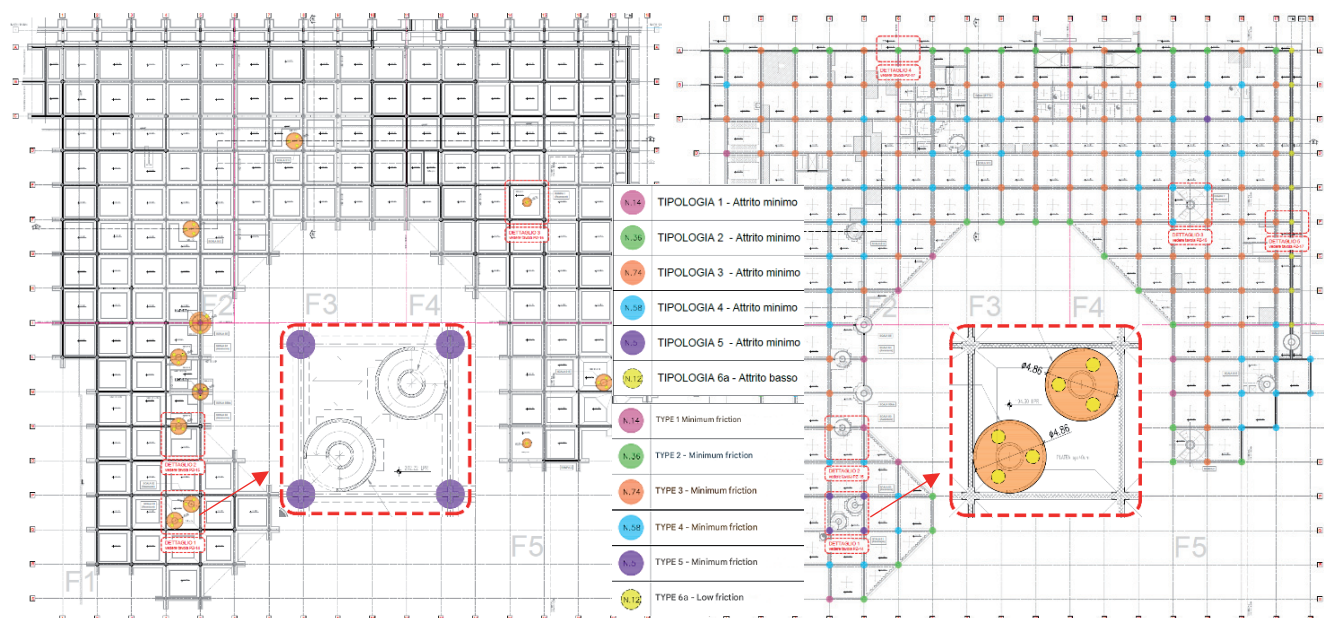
Stralcio dell'elaborato grafico di progetto: disposizione in pianta dei "friction pendulum" al di sotto del piano isolato (sinistra) e a livello fondazionale (destra)
